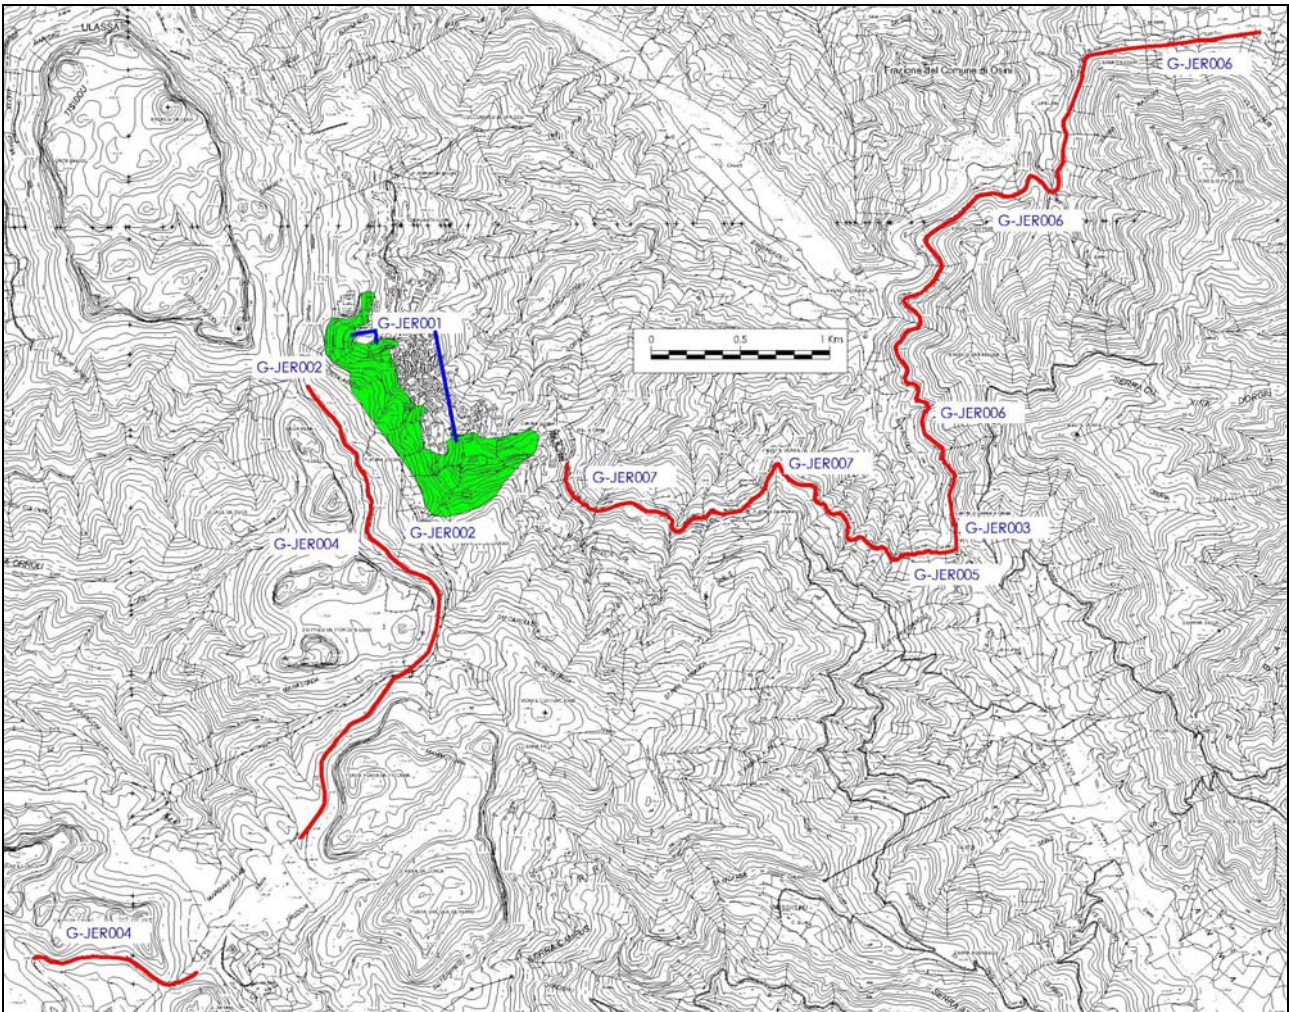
Comune di Gairo – Planimetria interventi mitigazione rischio franoso
